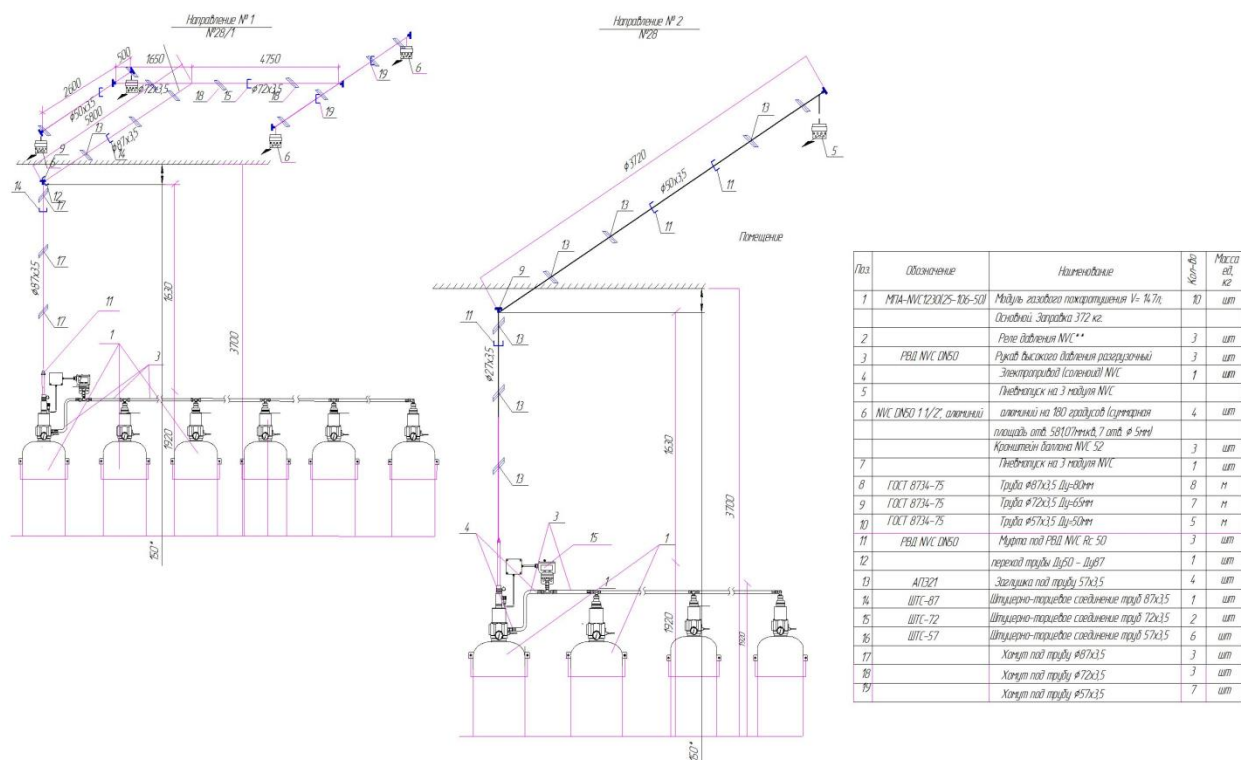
Схема размещения модулей, трубопроводов подачи огнетушащего вещества с насадками-распылителями
